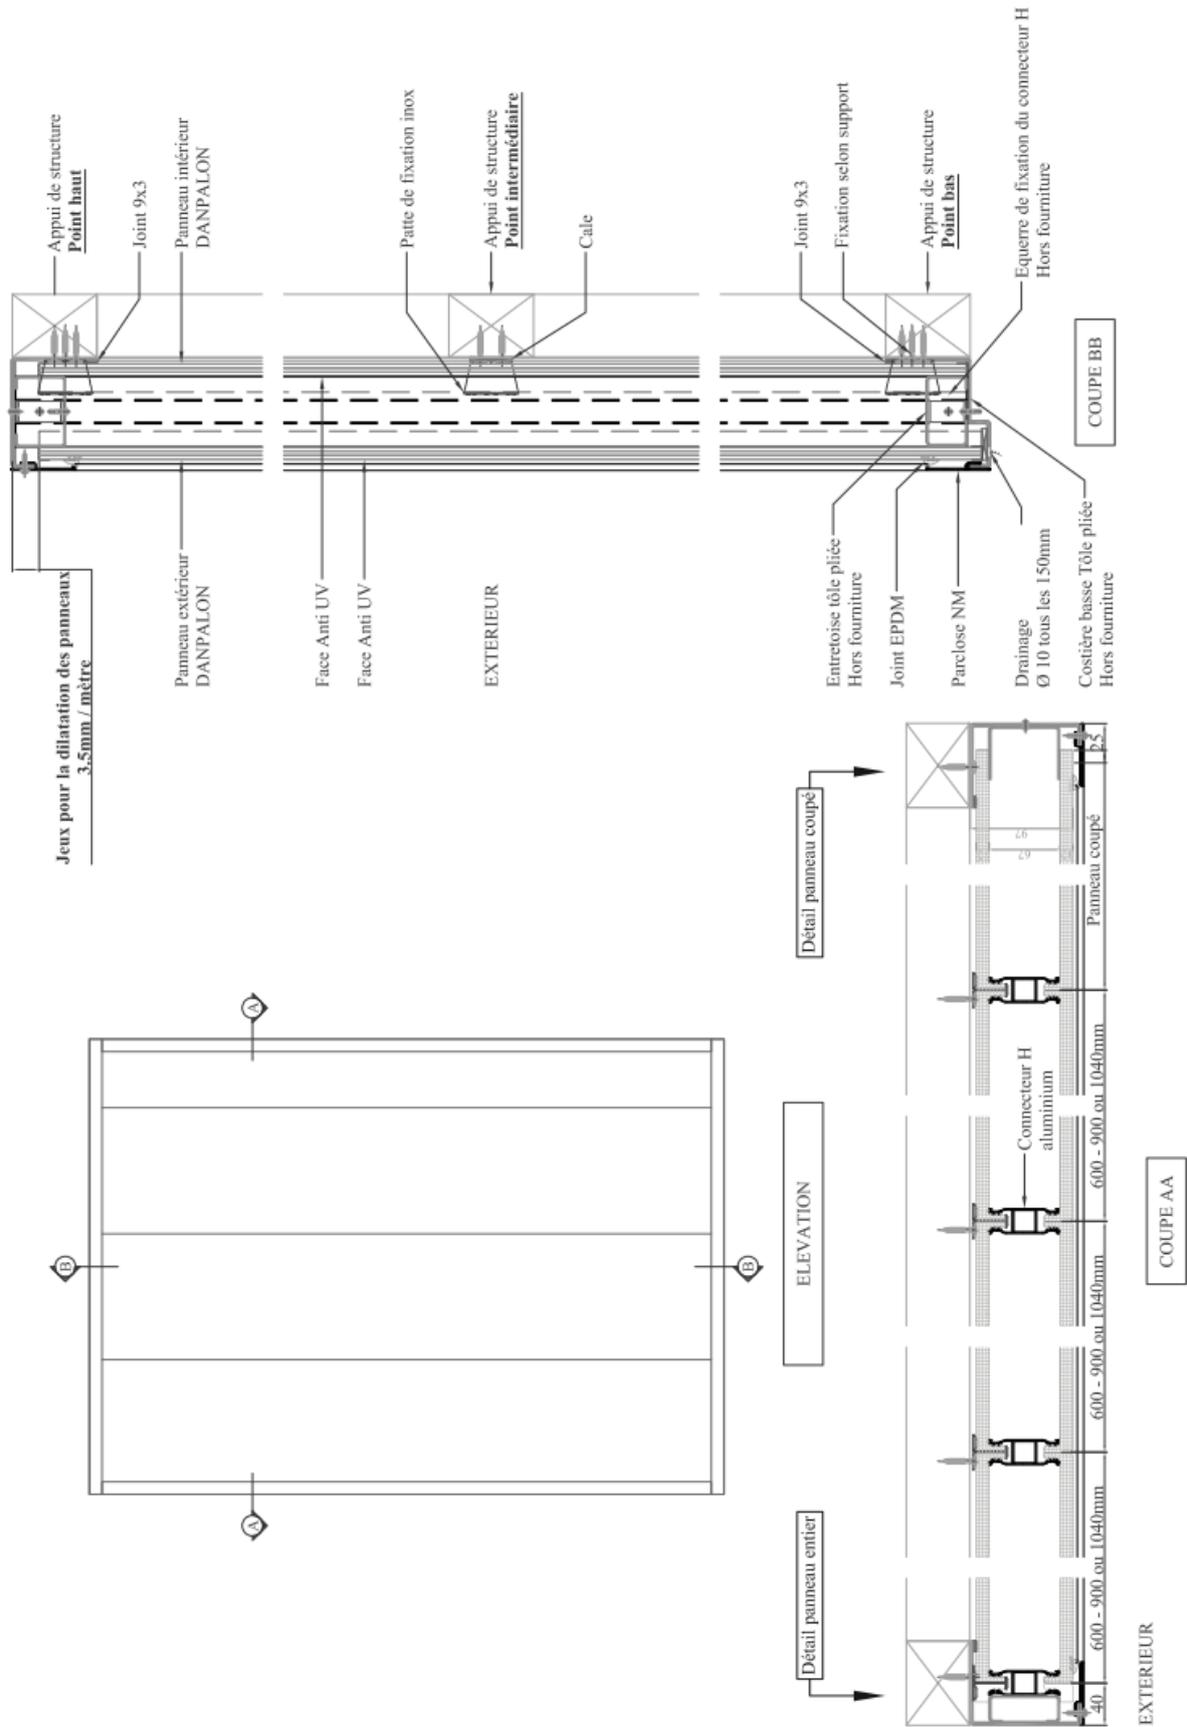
Coupe longitudinale et transversale sur connecteur H aluminium – Système DANPATHERM
